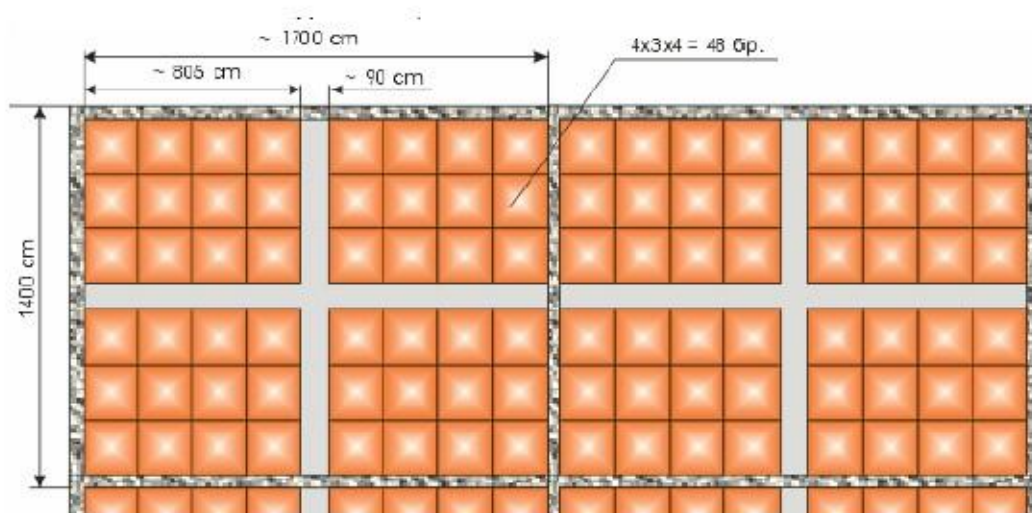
Vedere generala a camerei de stocare a containerelor de beton armat
